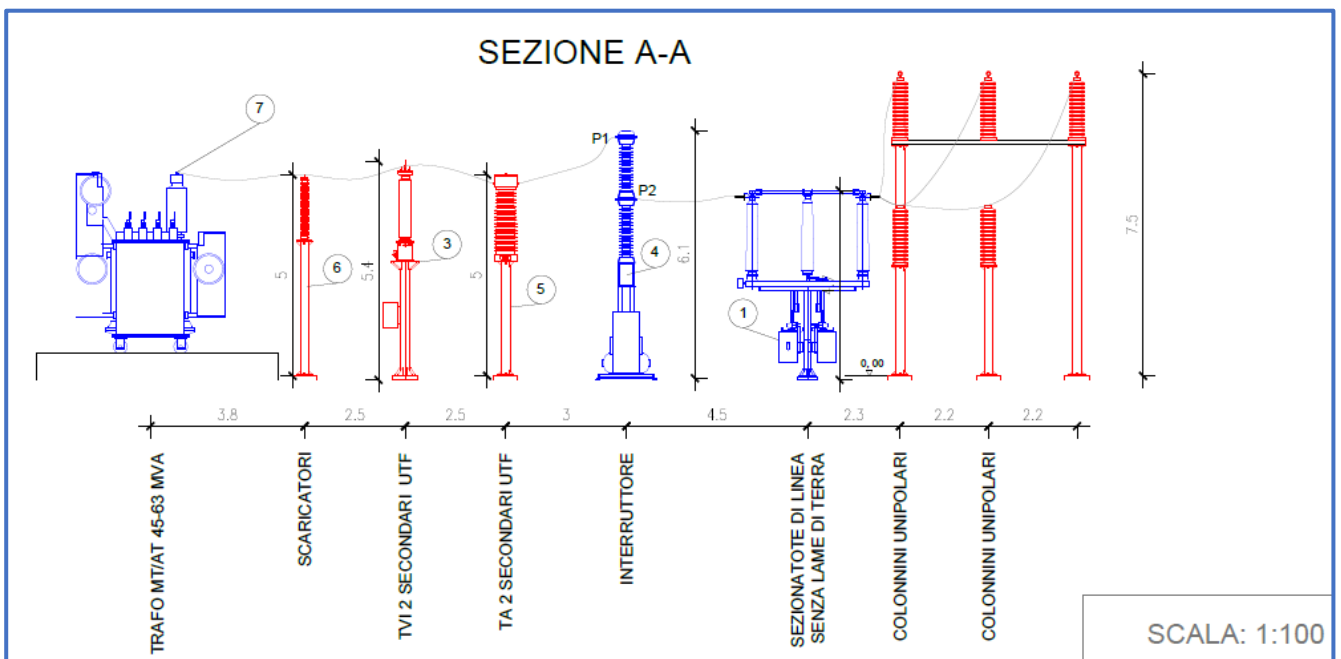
Vista in sezione delle apparecchiature da installare nella SU
